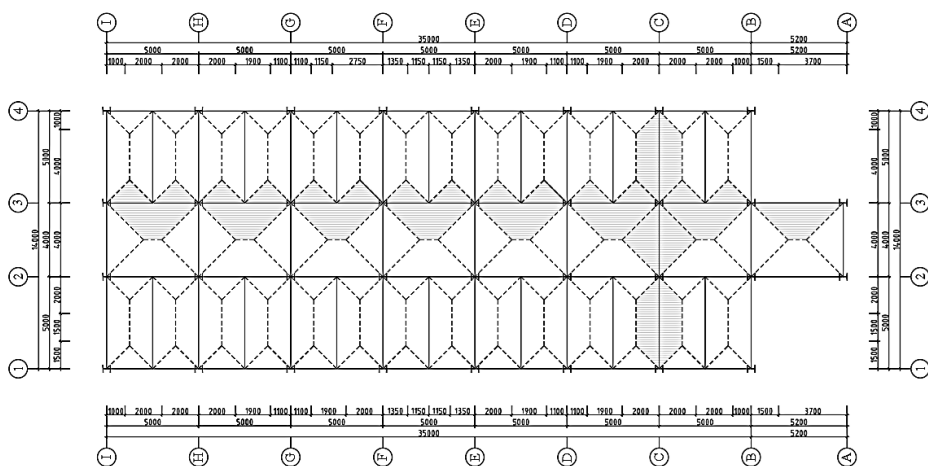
Denah Potongan Portal As C dan Portal As 3 Lantai 2
